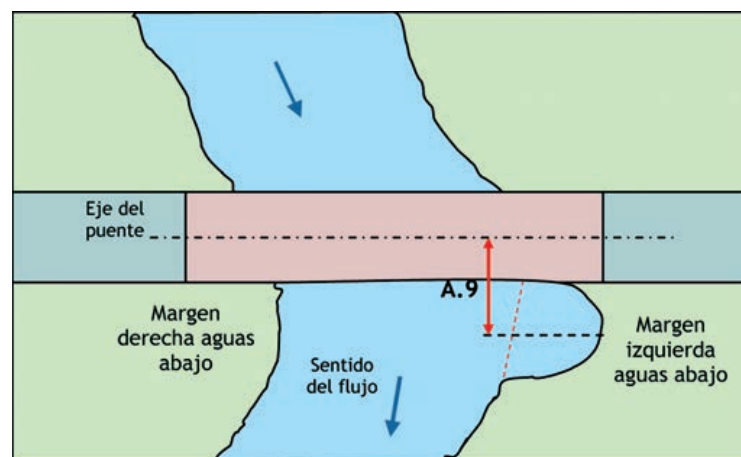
EROSIÓN POR EXPANSIÓN.
